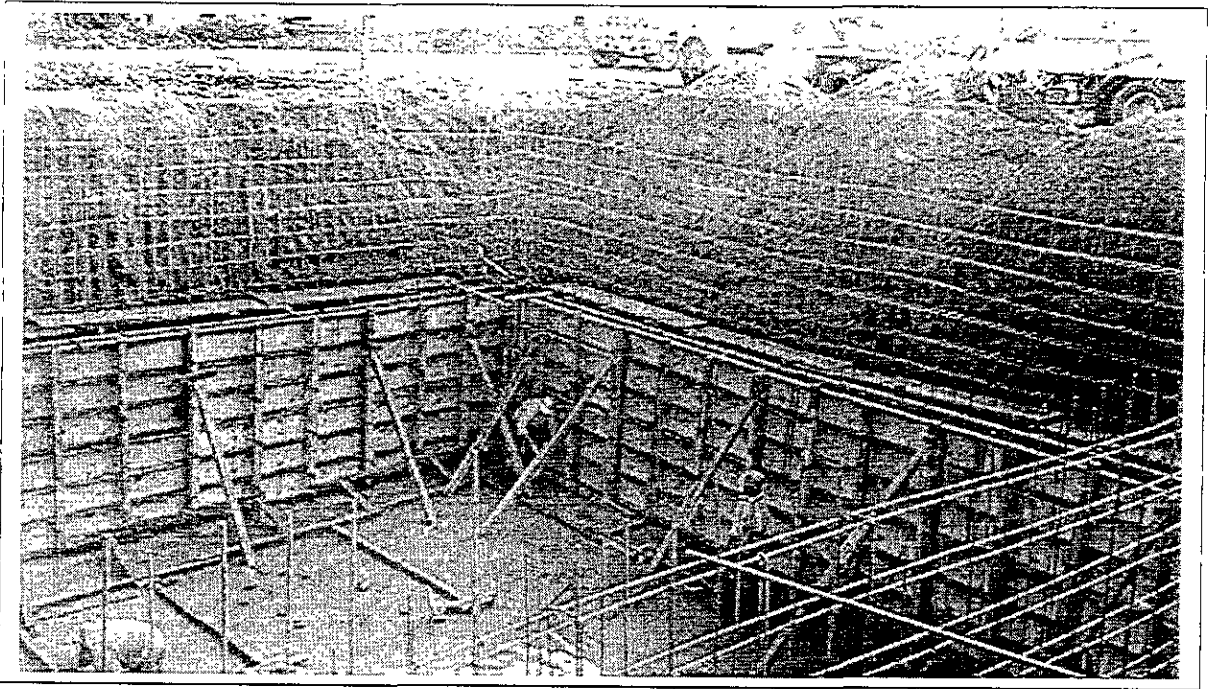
Colocación de cimbra para el colado del concreto de la fosa de tanques
